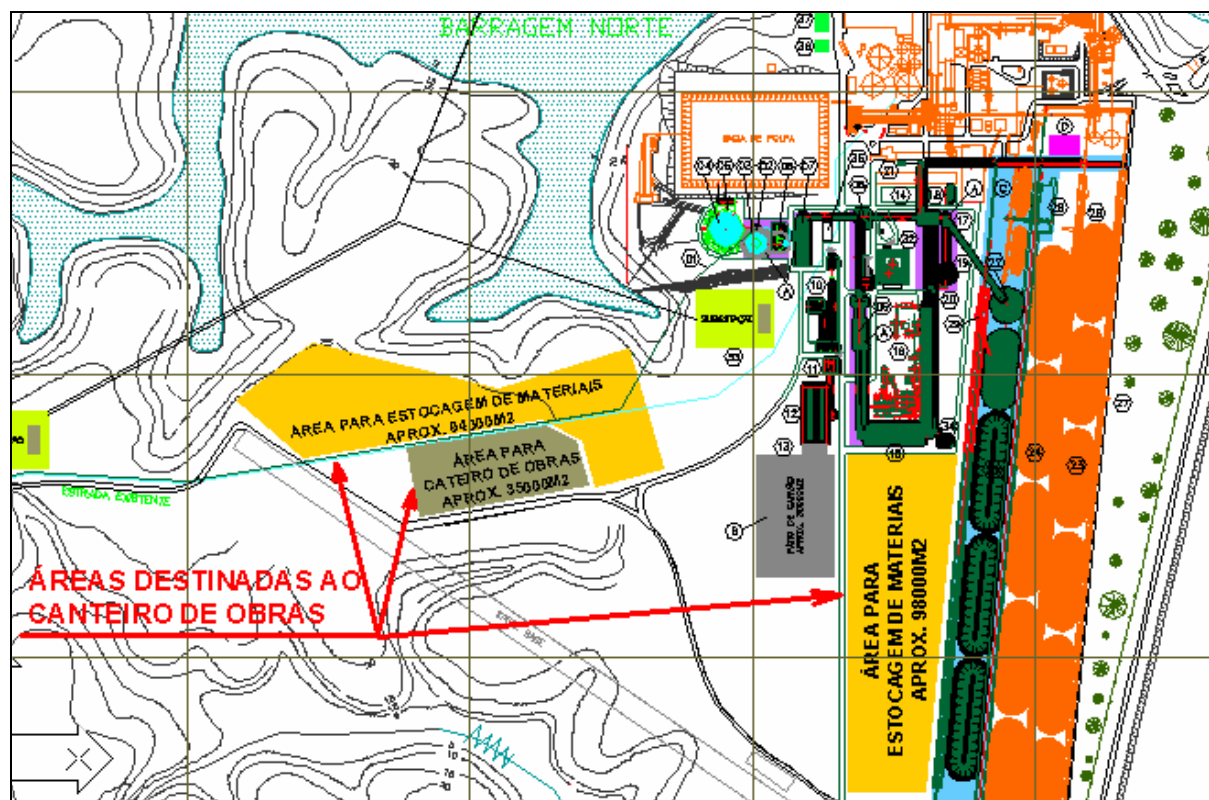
Desenho esquemático das áreas a serem utilizadas como Canteiro de Obras
